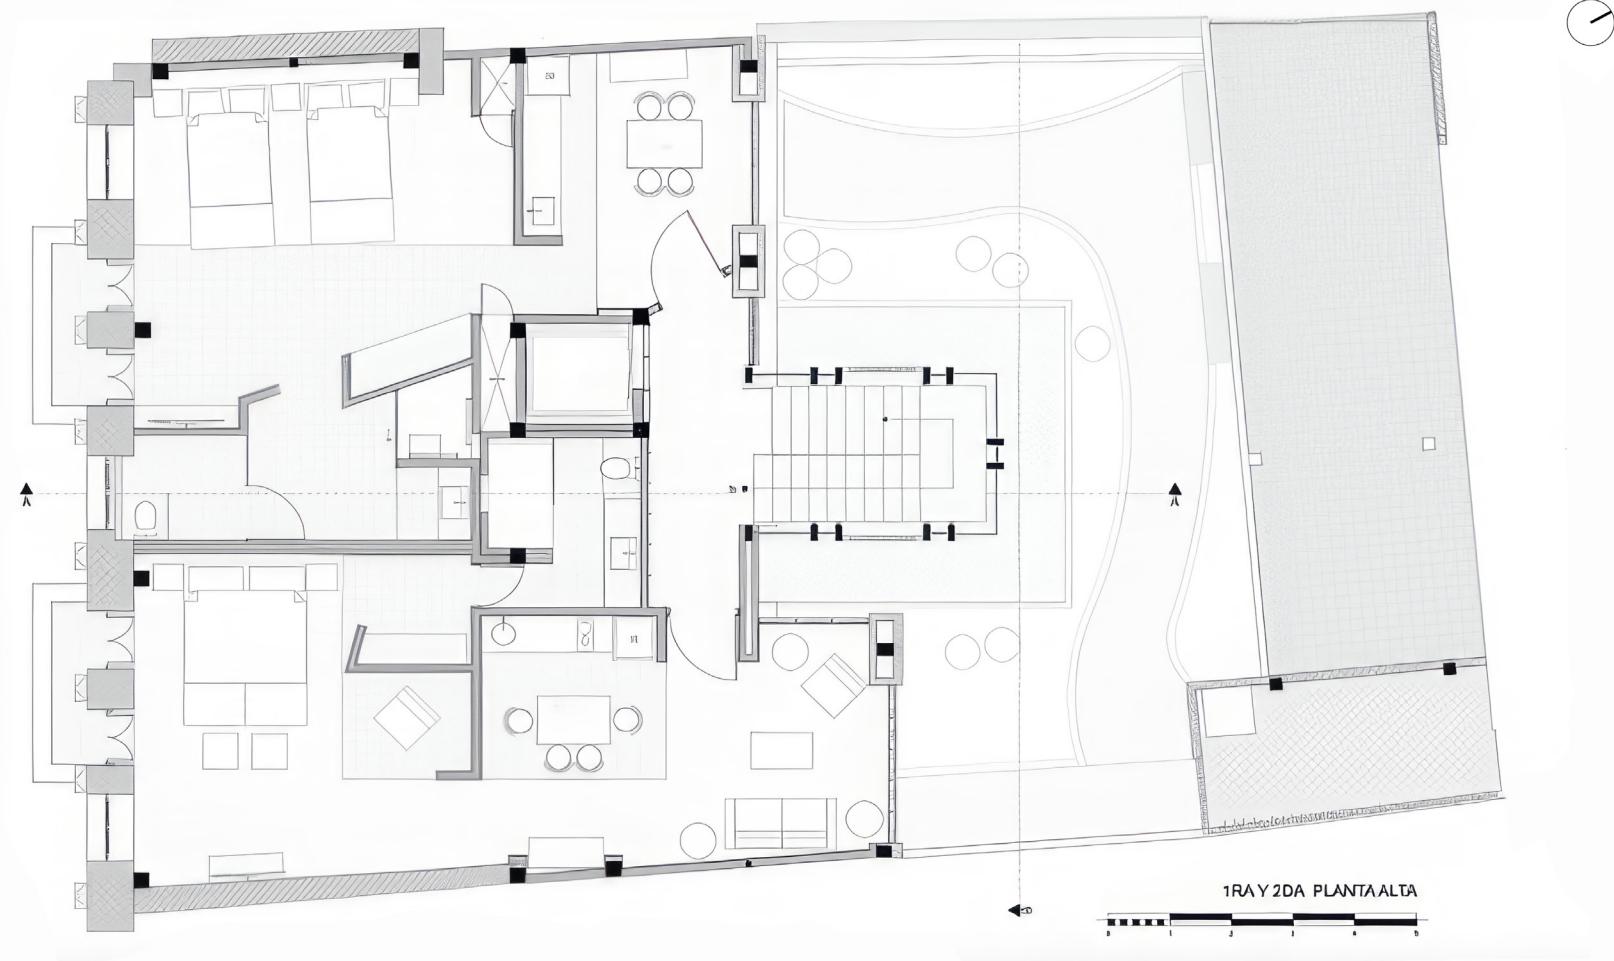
Planta suit Reales del Alcazar. Obtenida de Revista Inhaus e Inai Arquitectura
